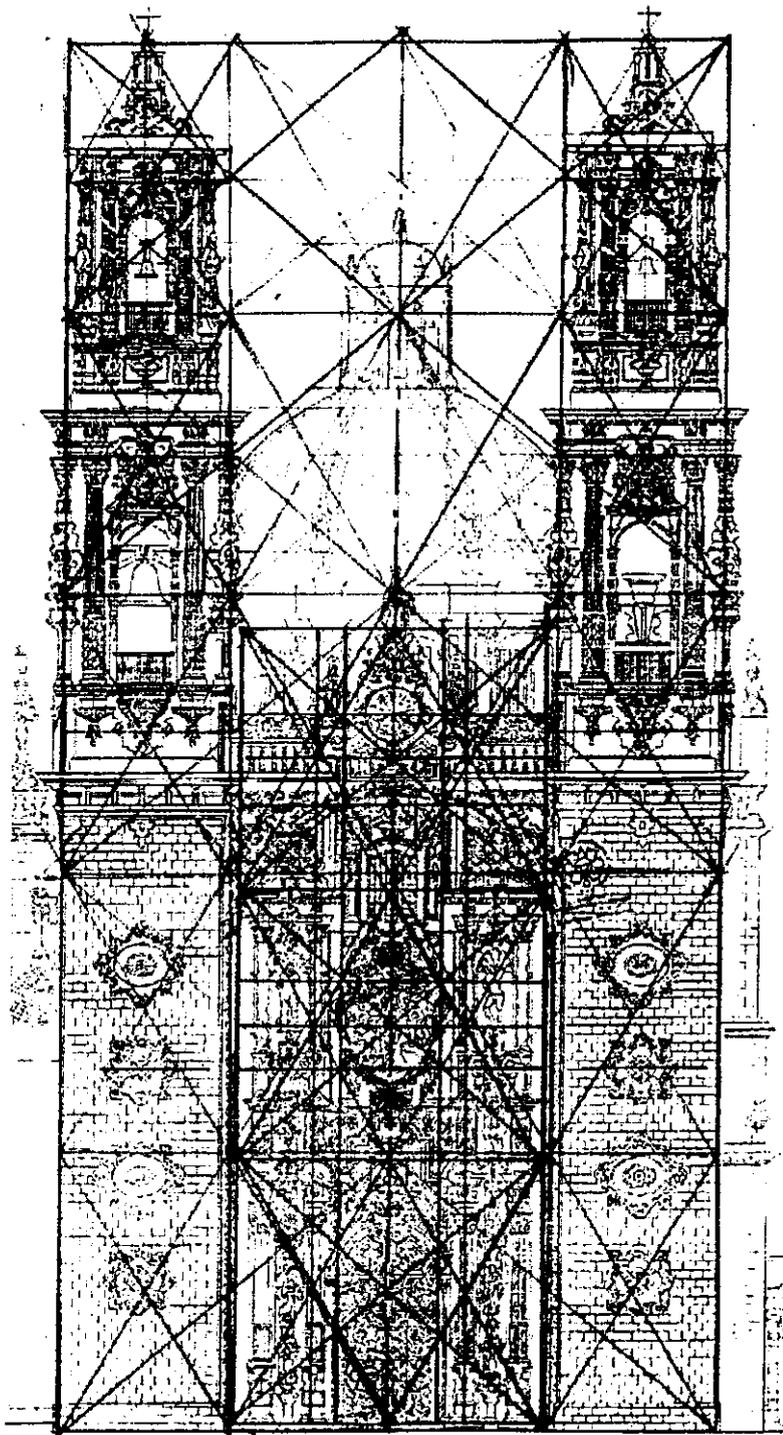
Trazo de la fachada principal y la portada, de la parroquia de Santa Prisca, Taxco, Guerrero.
